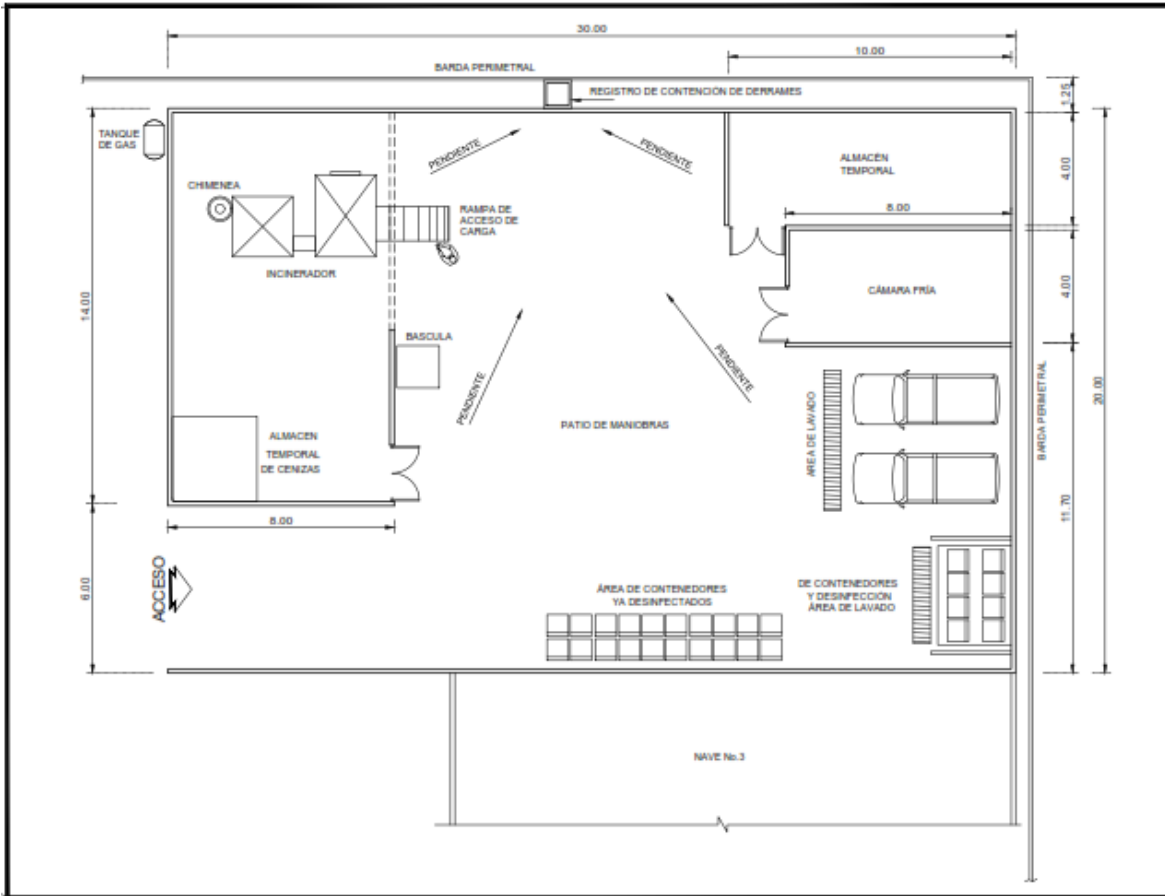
Área del Incinerador (para más detalles ver plano de Planta de Conjunto).
